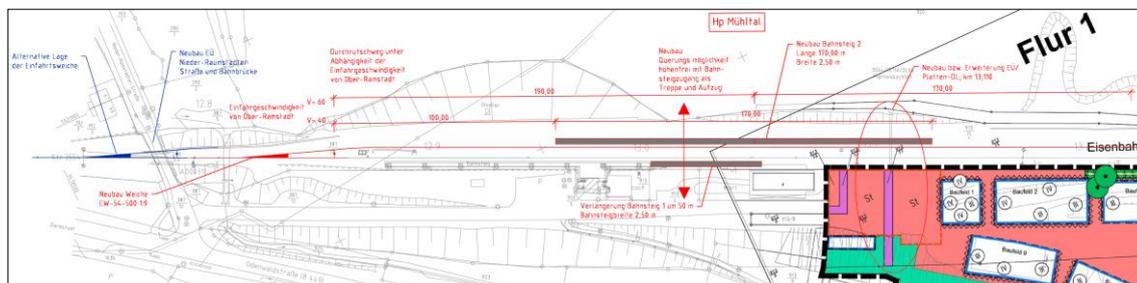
Lageplanausschnitt der Station Mühlthal
